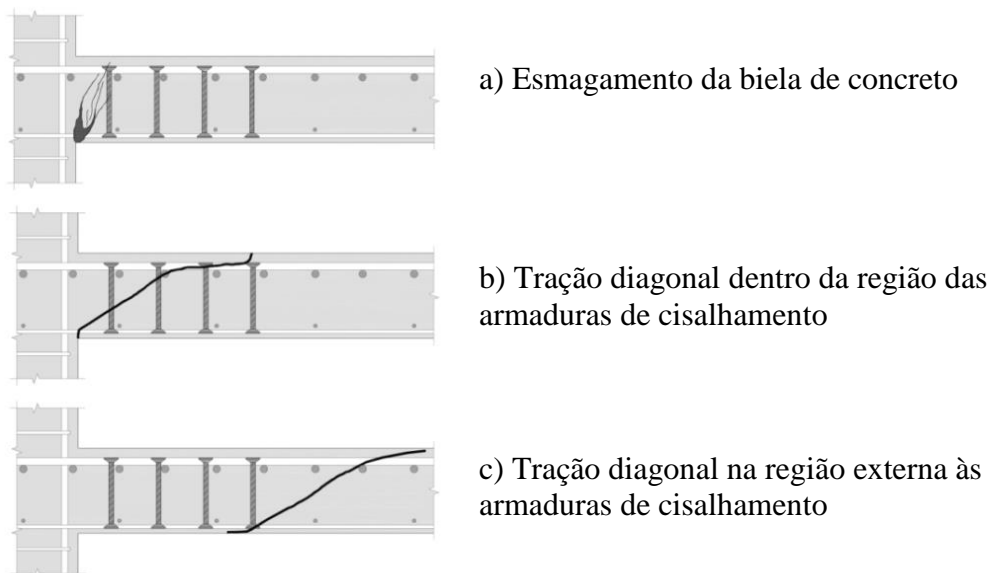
Modos de ruptura por punção em lajes lisas com armadura de cisalhamento.
